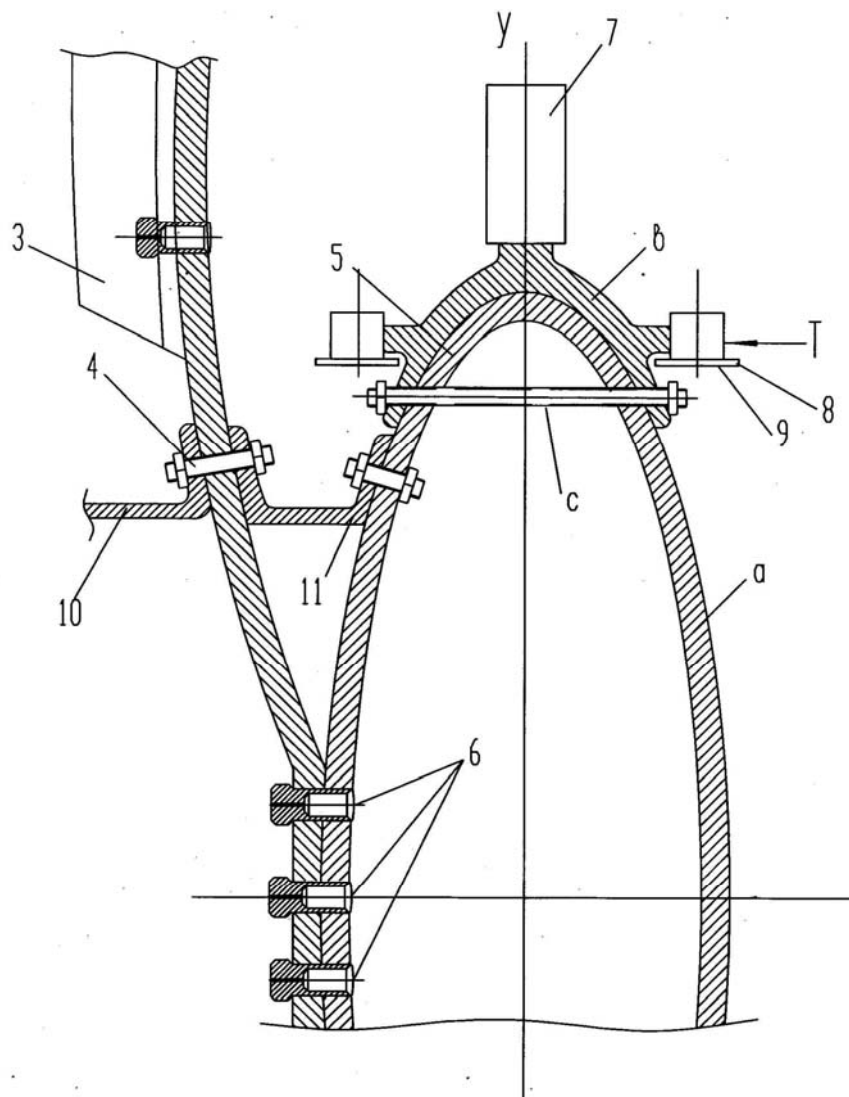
Сечение подкраново-подстропильной конструкции
